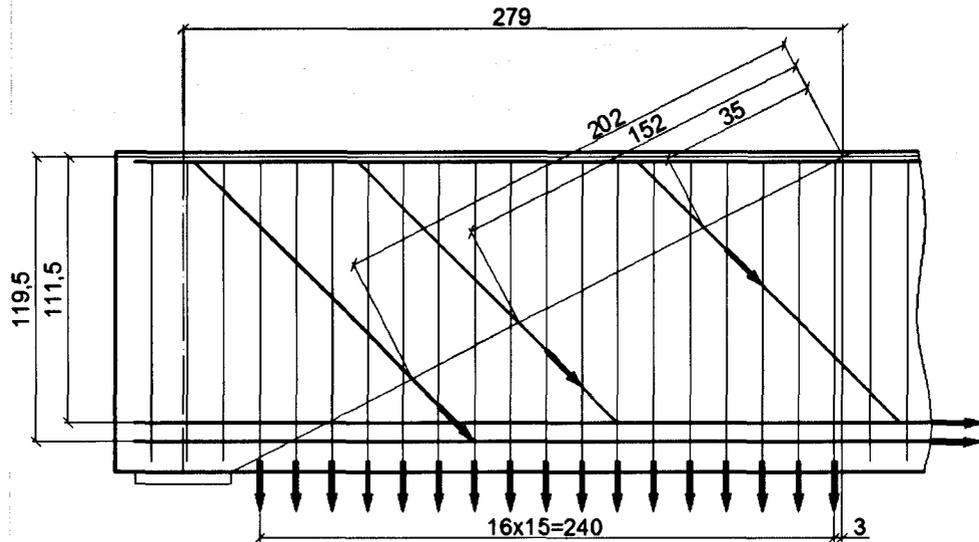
Расчетная схема к определению предельного изгибающего момента
